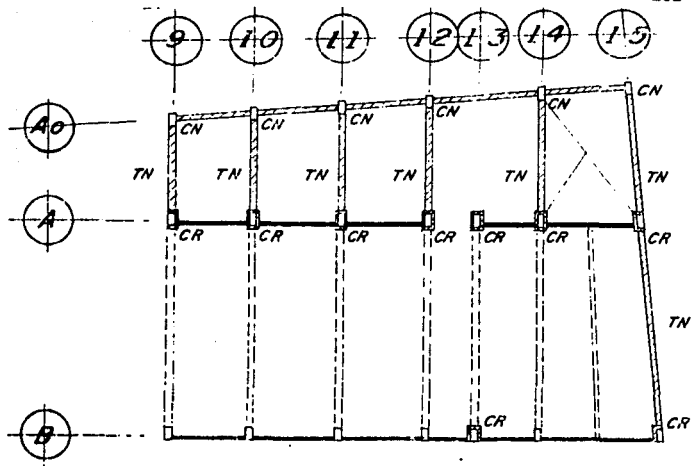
Planta de contraventeo metálico sobre ejes 9 y 15.
